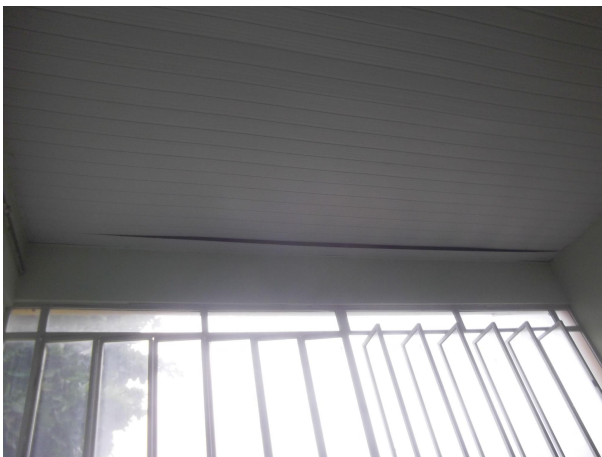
Vista de deslocamento do forro em pvc (07/05/2018).
